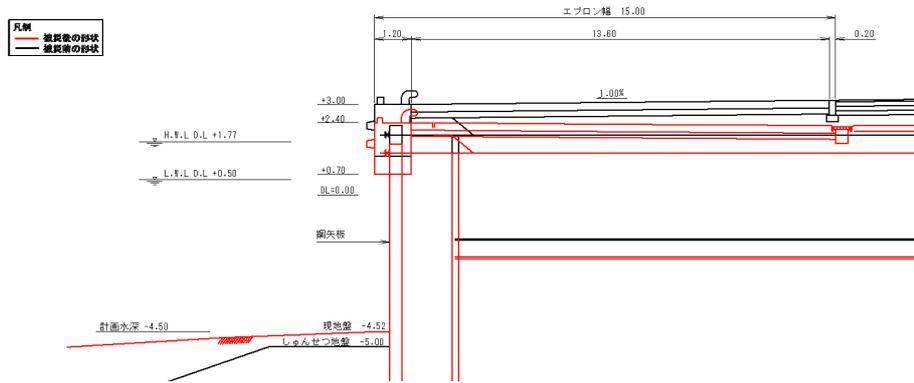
塩釜港区\_中ふ頭東側岸壁の断面図 (被災後)
